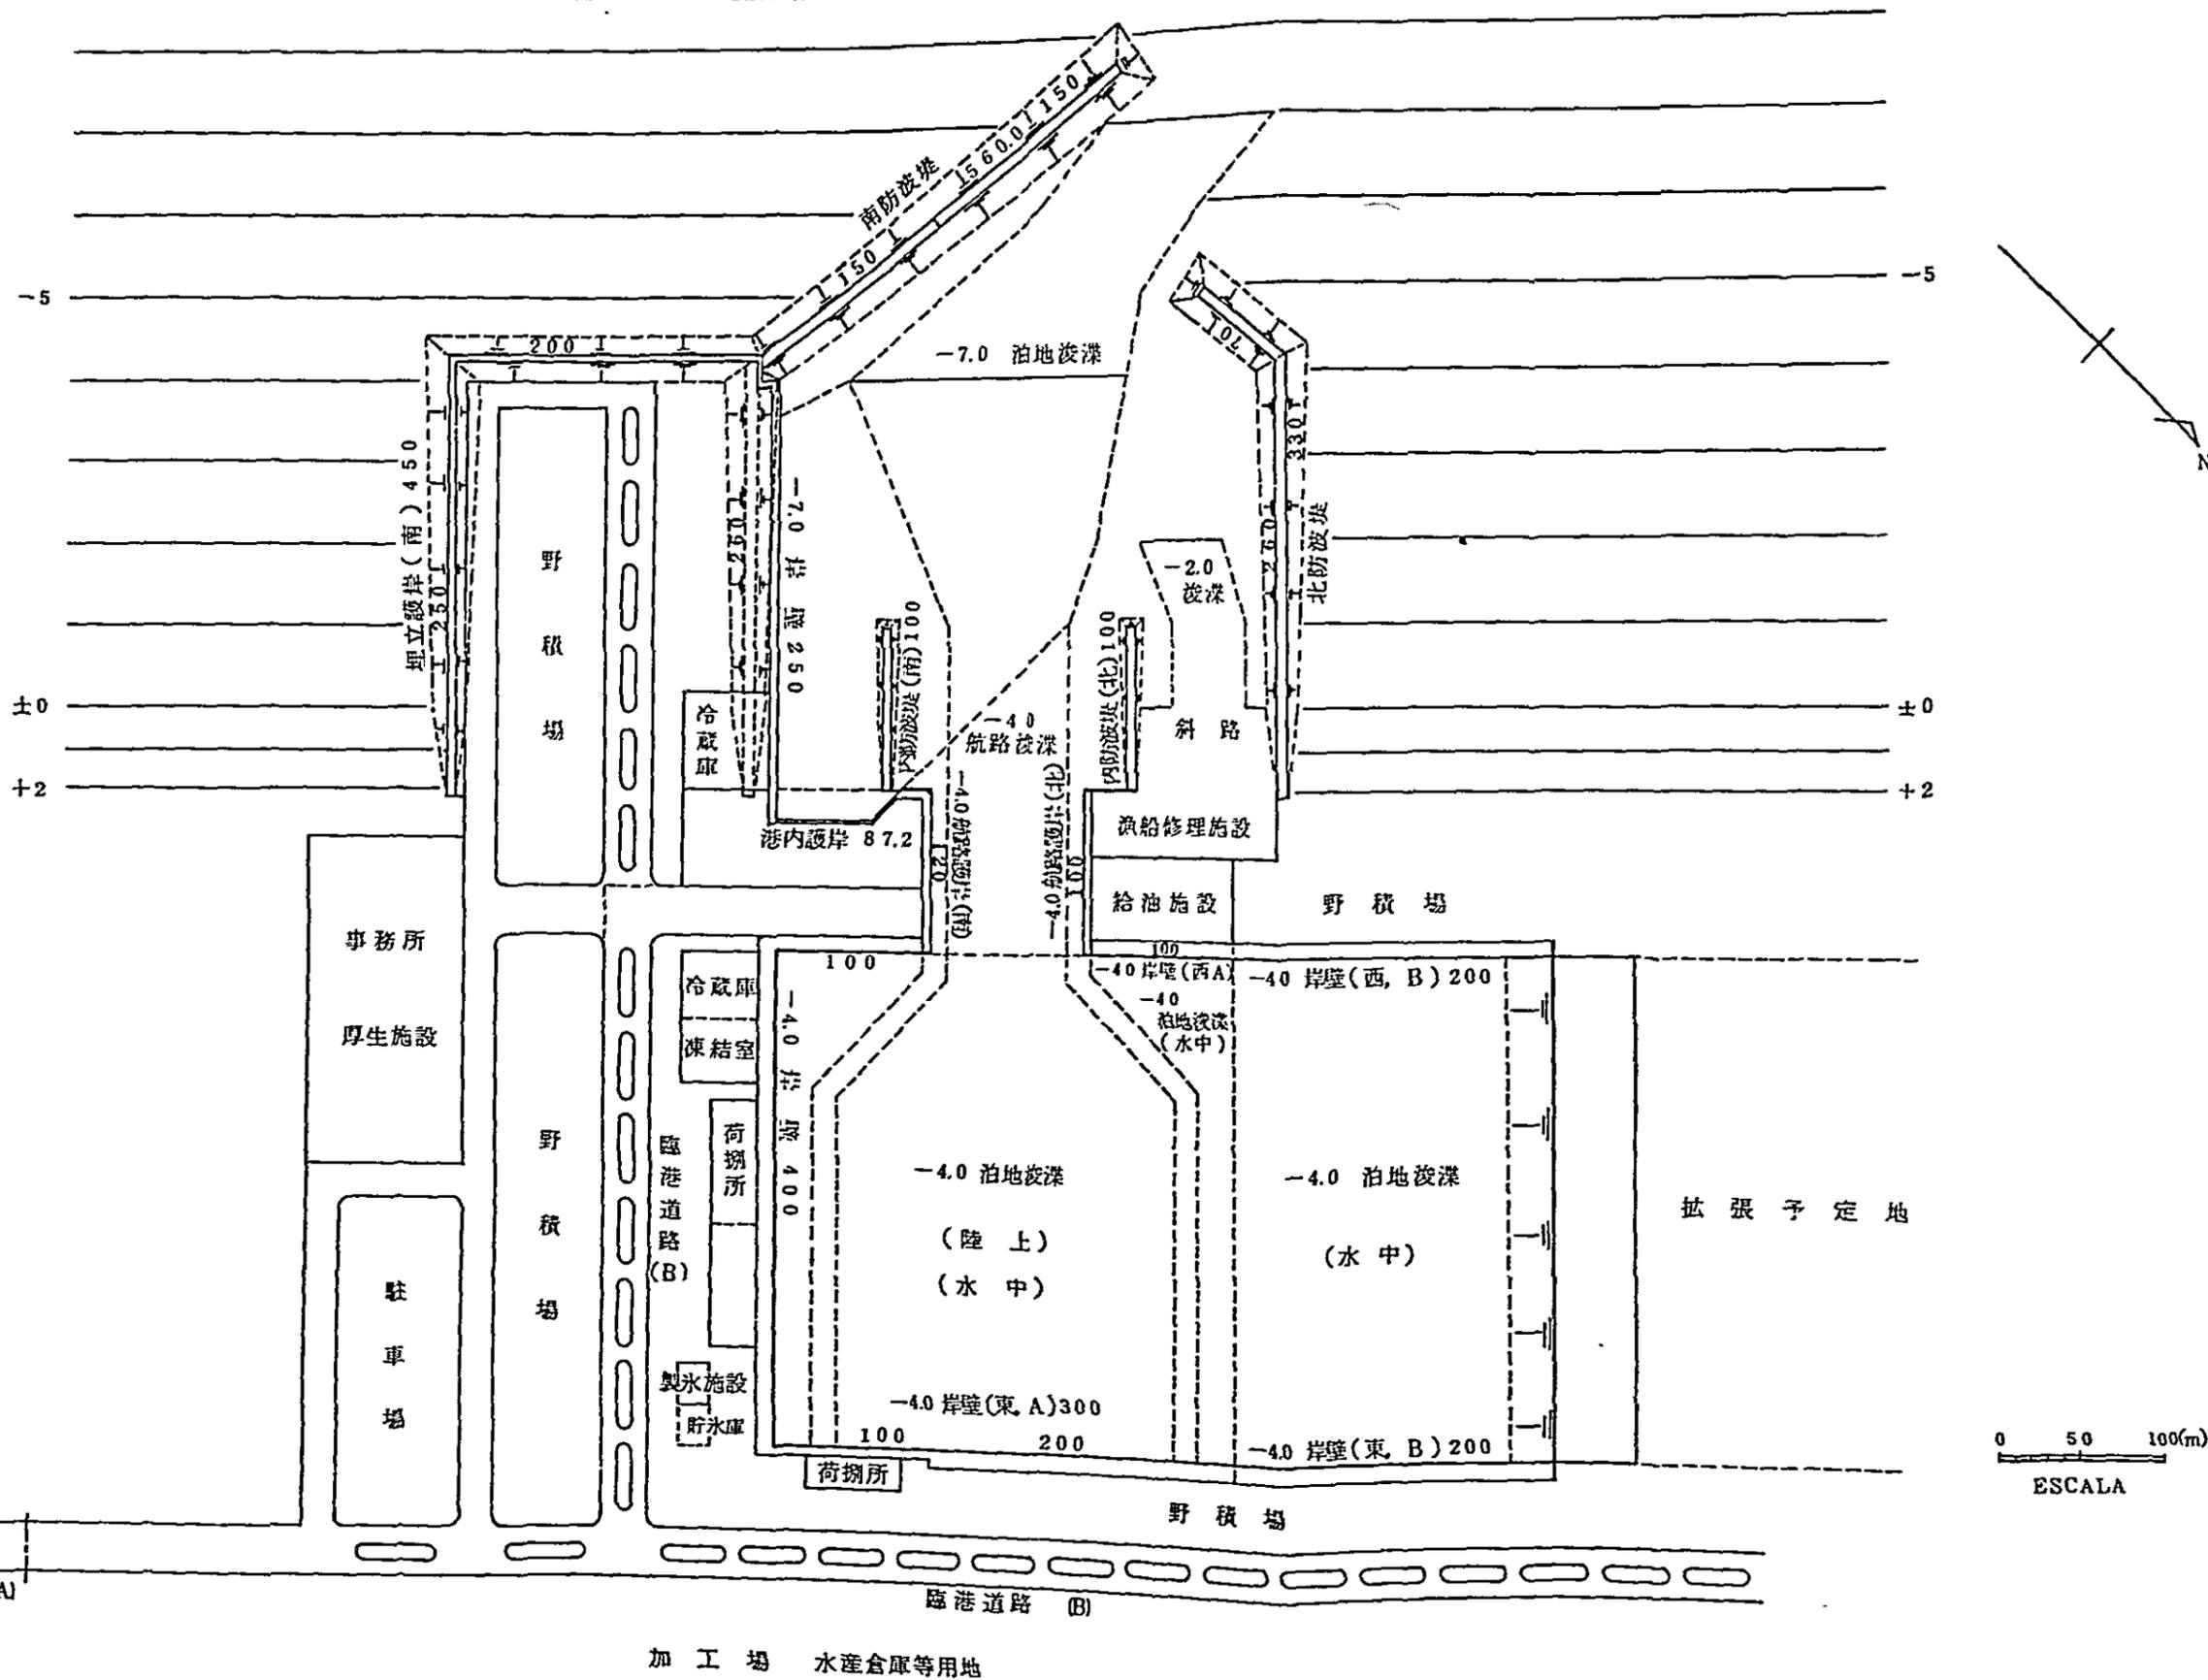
建設段階別ペンタニーヤ漁業基地計画平面図③(完成時)
